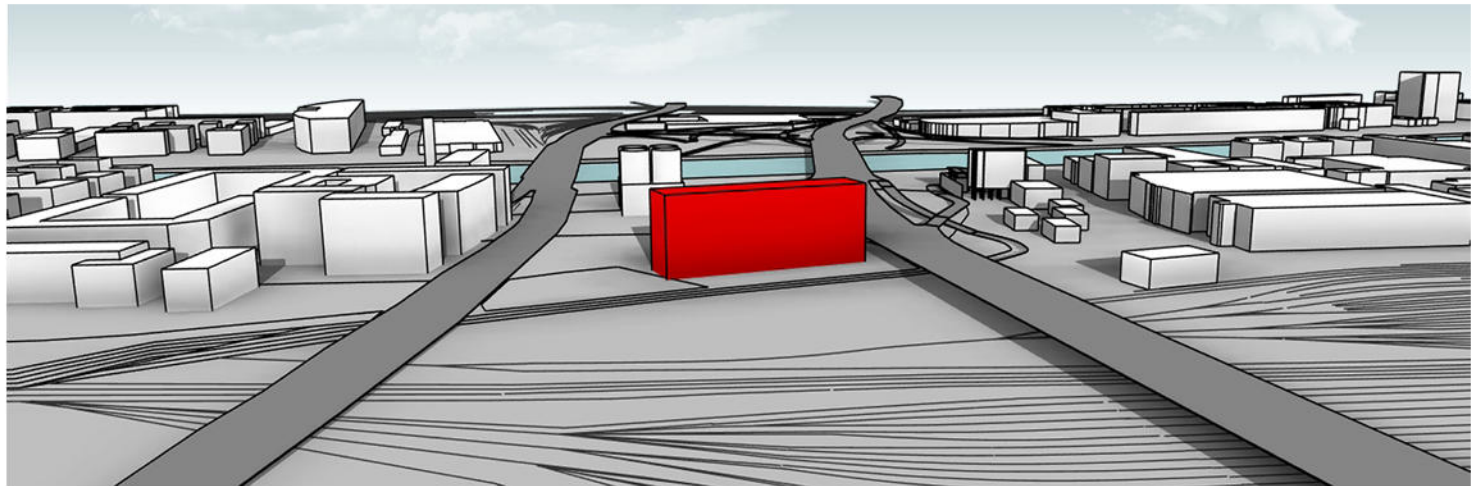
Vista prospettica - Rapporto dell'architettura con il suo contesto
